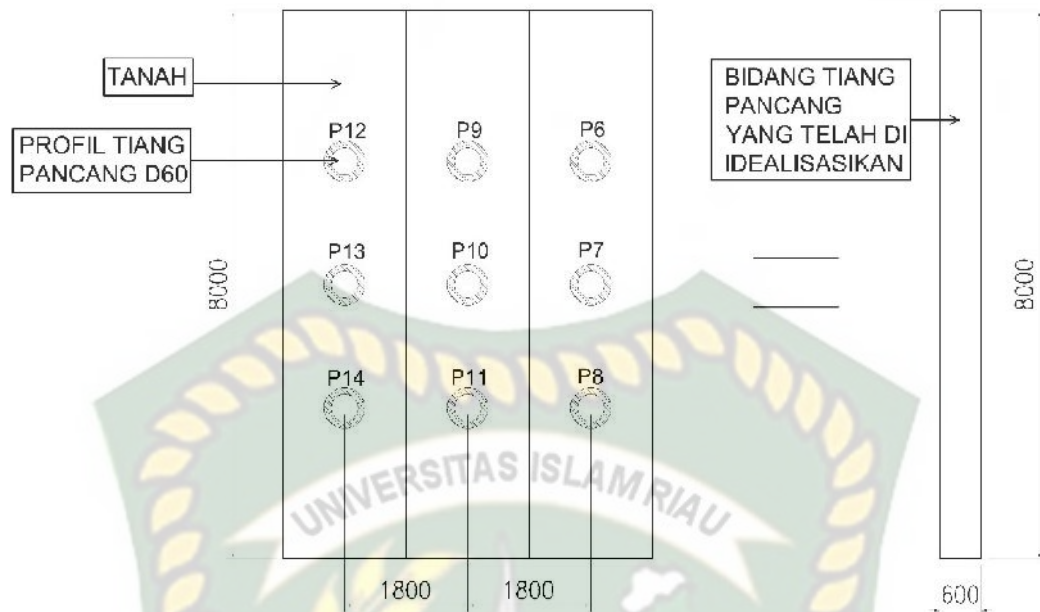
Potongan tiang pancang (*Spun pile*) yang ditinjau
